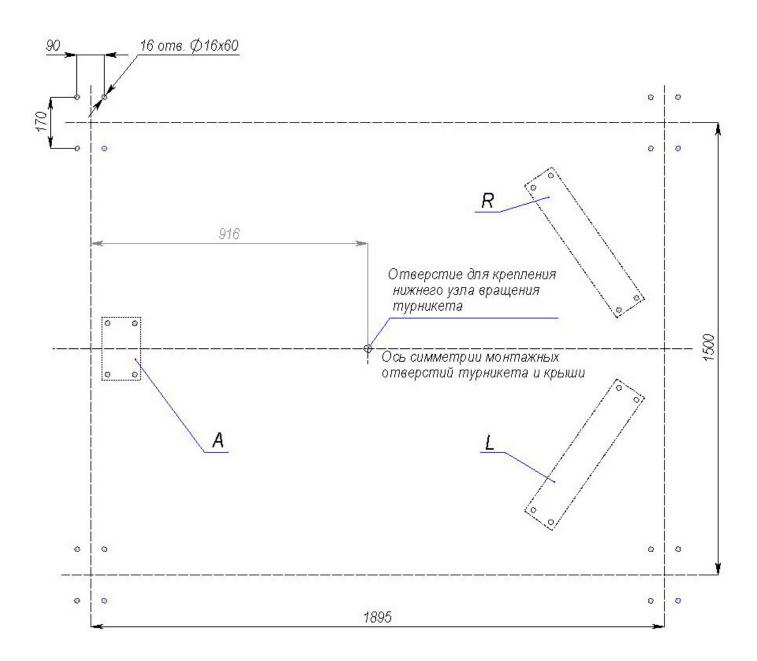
Схема разметки отверстий для крепления стоек (3) крыши относительно отверстий для крепления турникета:
